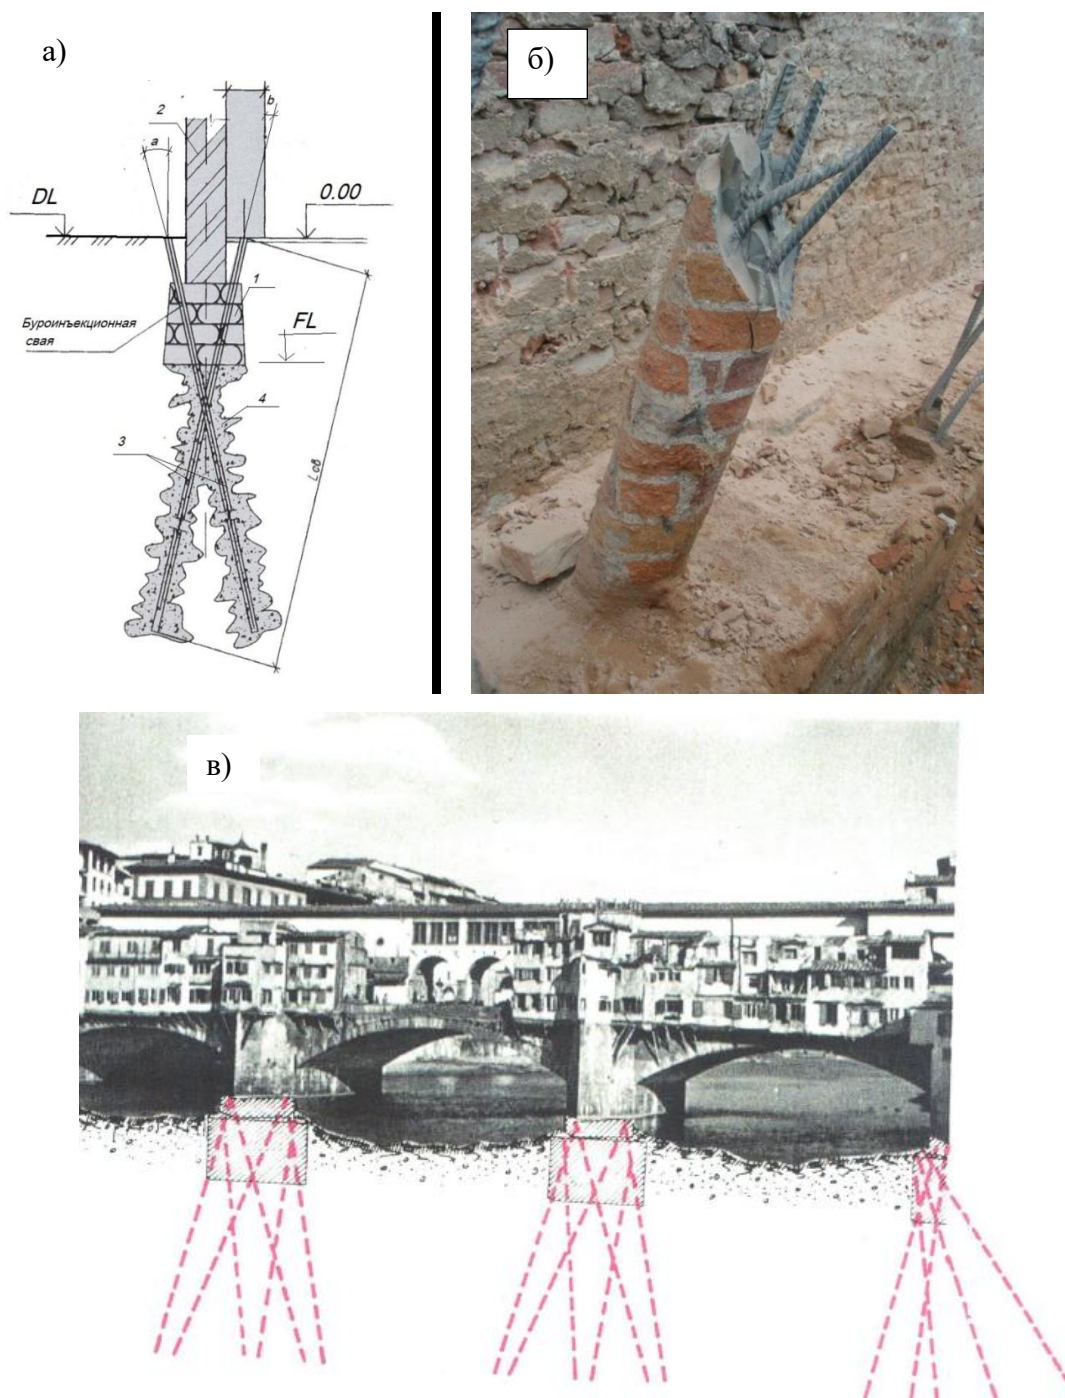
Увеличение несущей способности ленточного бутового фундамента с устройством буроинъекционных свай: а) схема устройства наклонных буроинъекционных свай с заделкой в фундаменте; 1- усиливаемый фундамент; 2- кирпичная стена; 3 – буроинъекционные сваи; 4 – зона закрепленного вокруг буроинъекционной сваи грунта; б) вид буроинъекционной сваи с пространственным арматурным каркасом; в) пример из книги Ф.Лиззи (F.Lizzi, 1982) – схема усиления фундаментов моста Понте Веккьо, его еще называют Золотым мостом (Ponte Vecchio, 1345), выполненное в 1962-1963 годах во Флоренции (Италия).
